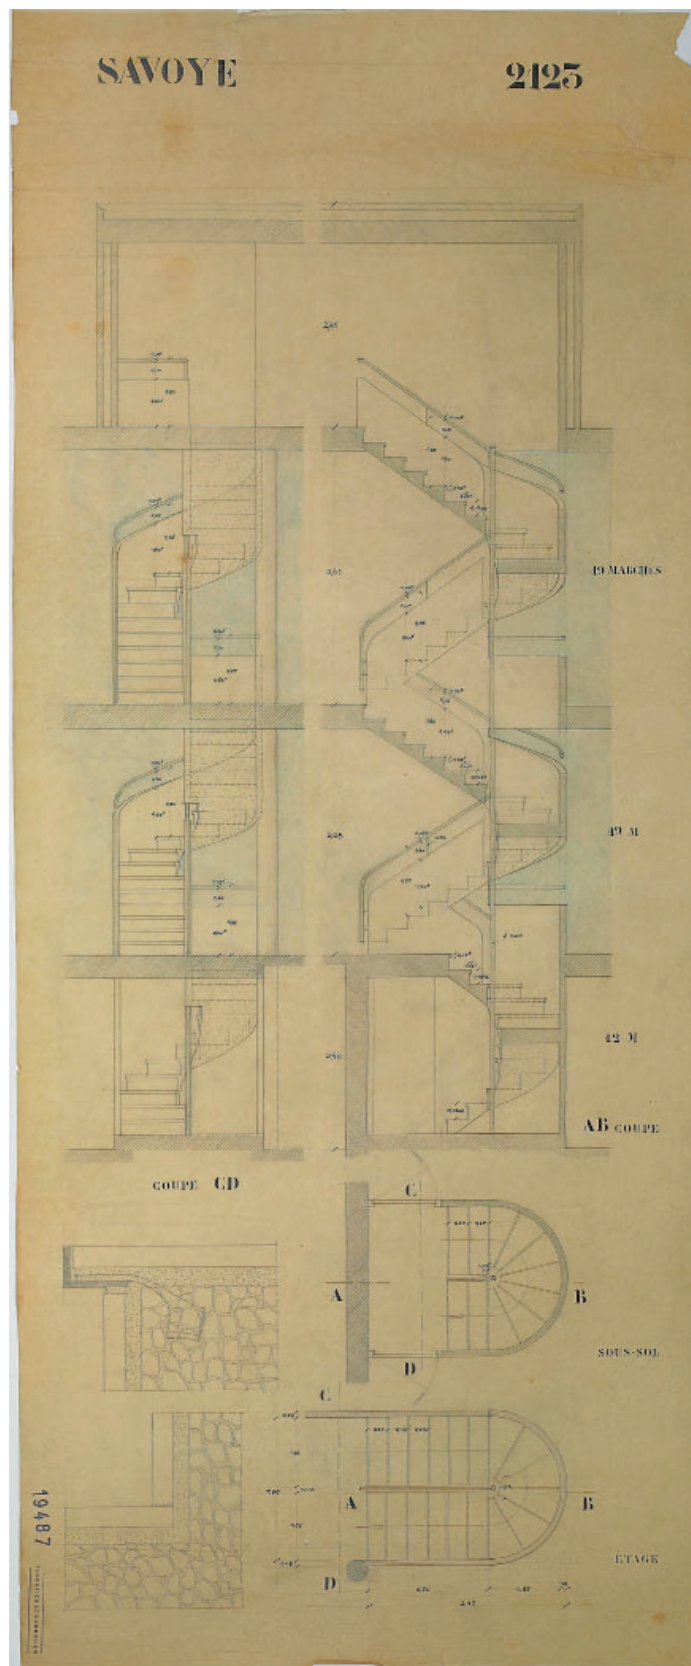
Plano constructivo de la escalera de la Villa Savoye, a escala 1:20, Atelier LC-PJ. FLC 19487.
